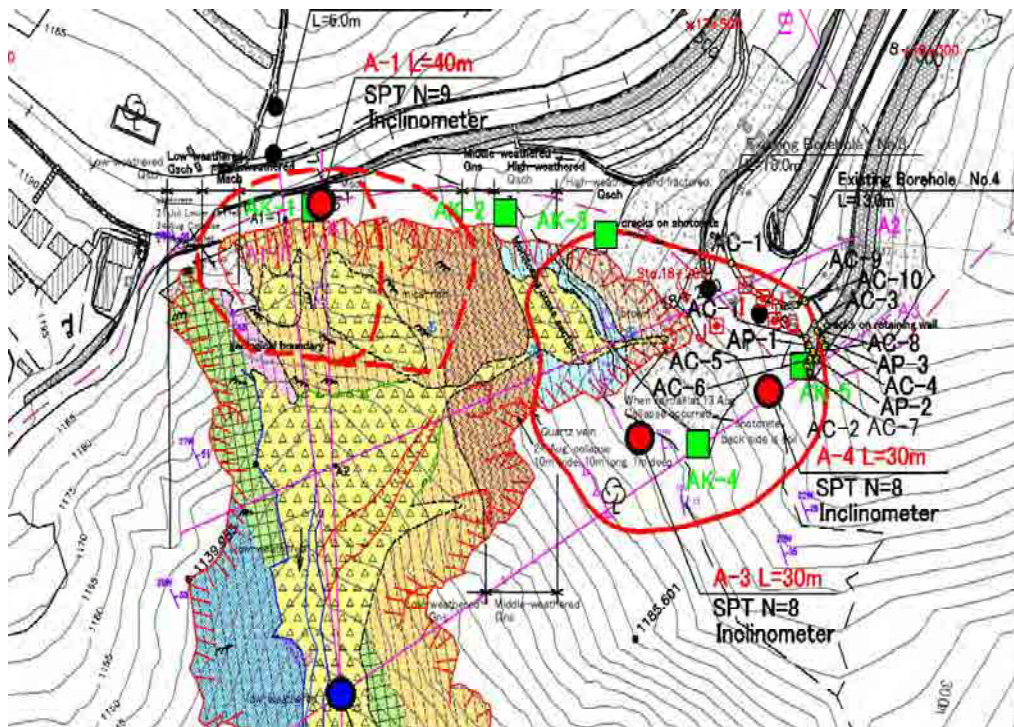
Cブロック平面図および地質断面図 (出典:準備調査その1報告書)
